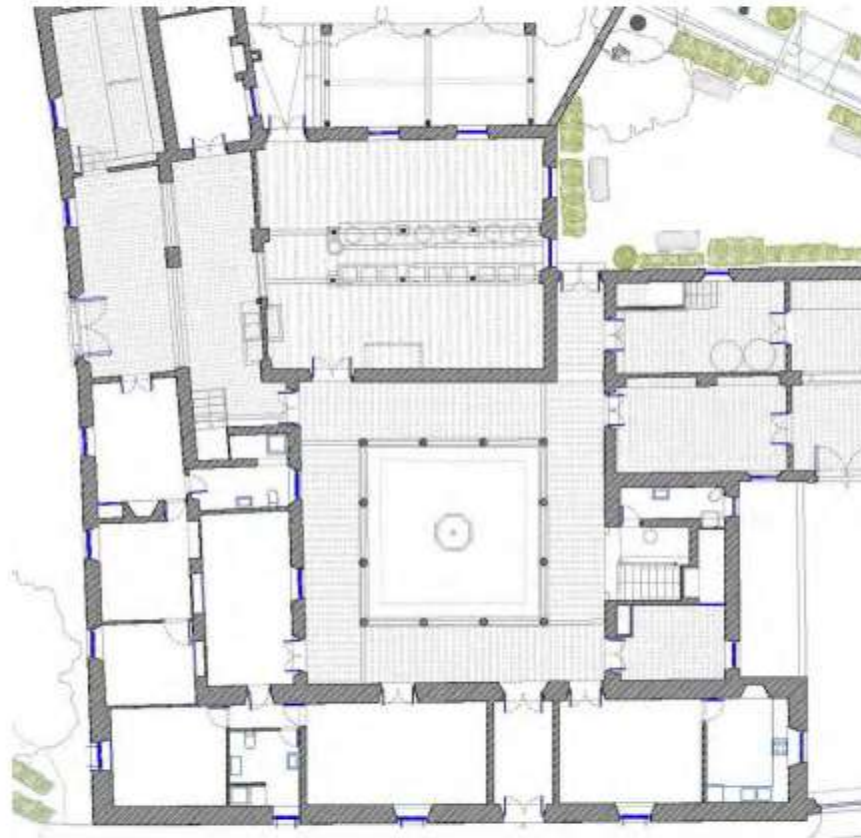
Detalle de planta de nivel inferior con proyección de estructura de techo.
